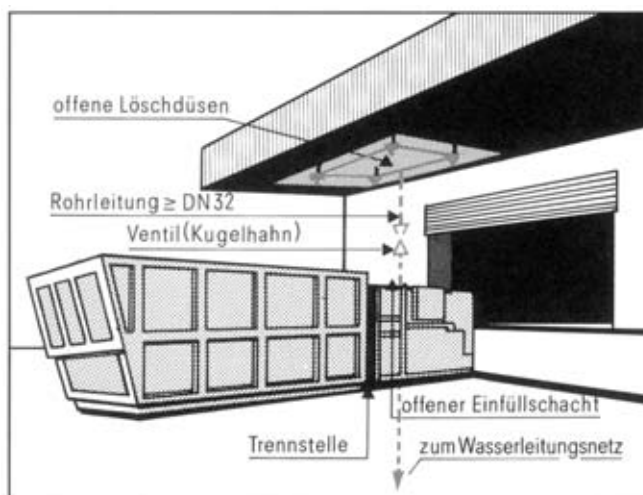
Offener Einfüllschacht unter Rampen oder Vordächern mit einer von Hand auslösbaren Löschanlage
